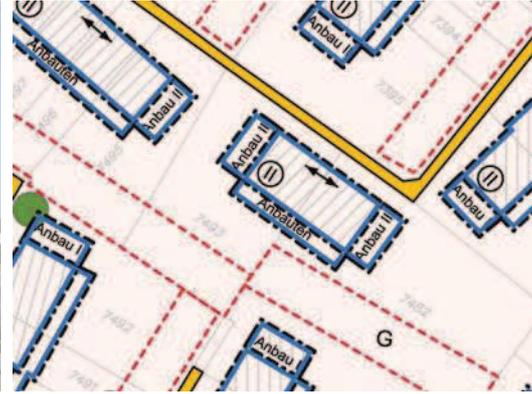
(rechts): Ausschnitt Bebauungsplan
